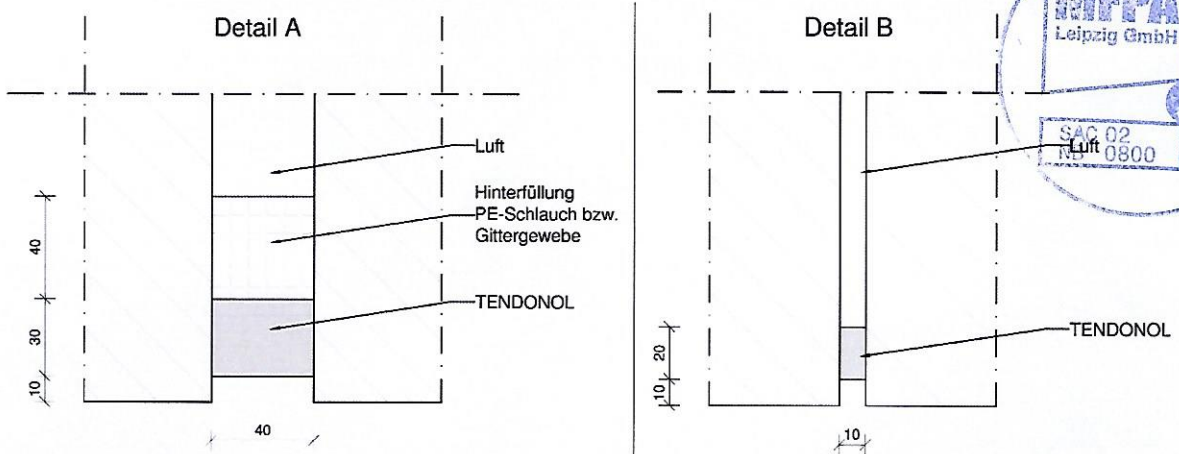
Detailzeichnungen der Beton-Bauteilfugen
